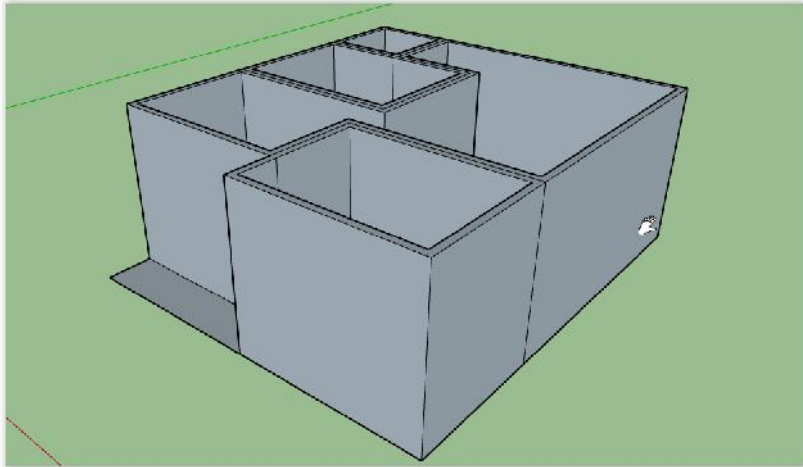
Sudut Pandang Perspektif Denah Rumah
